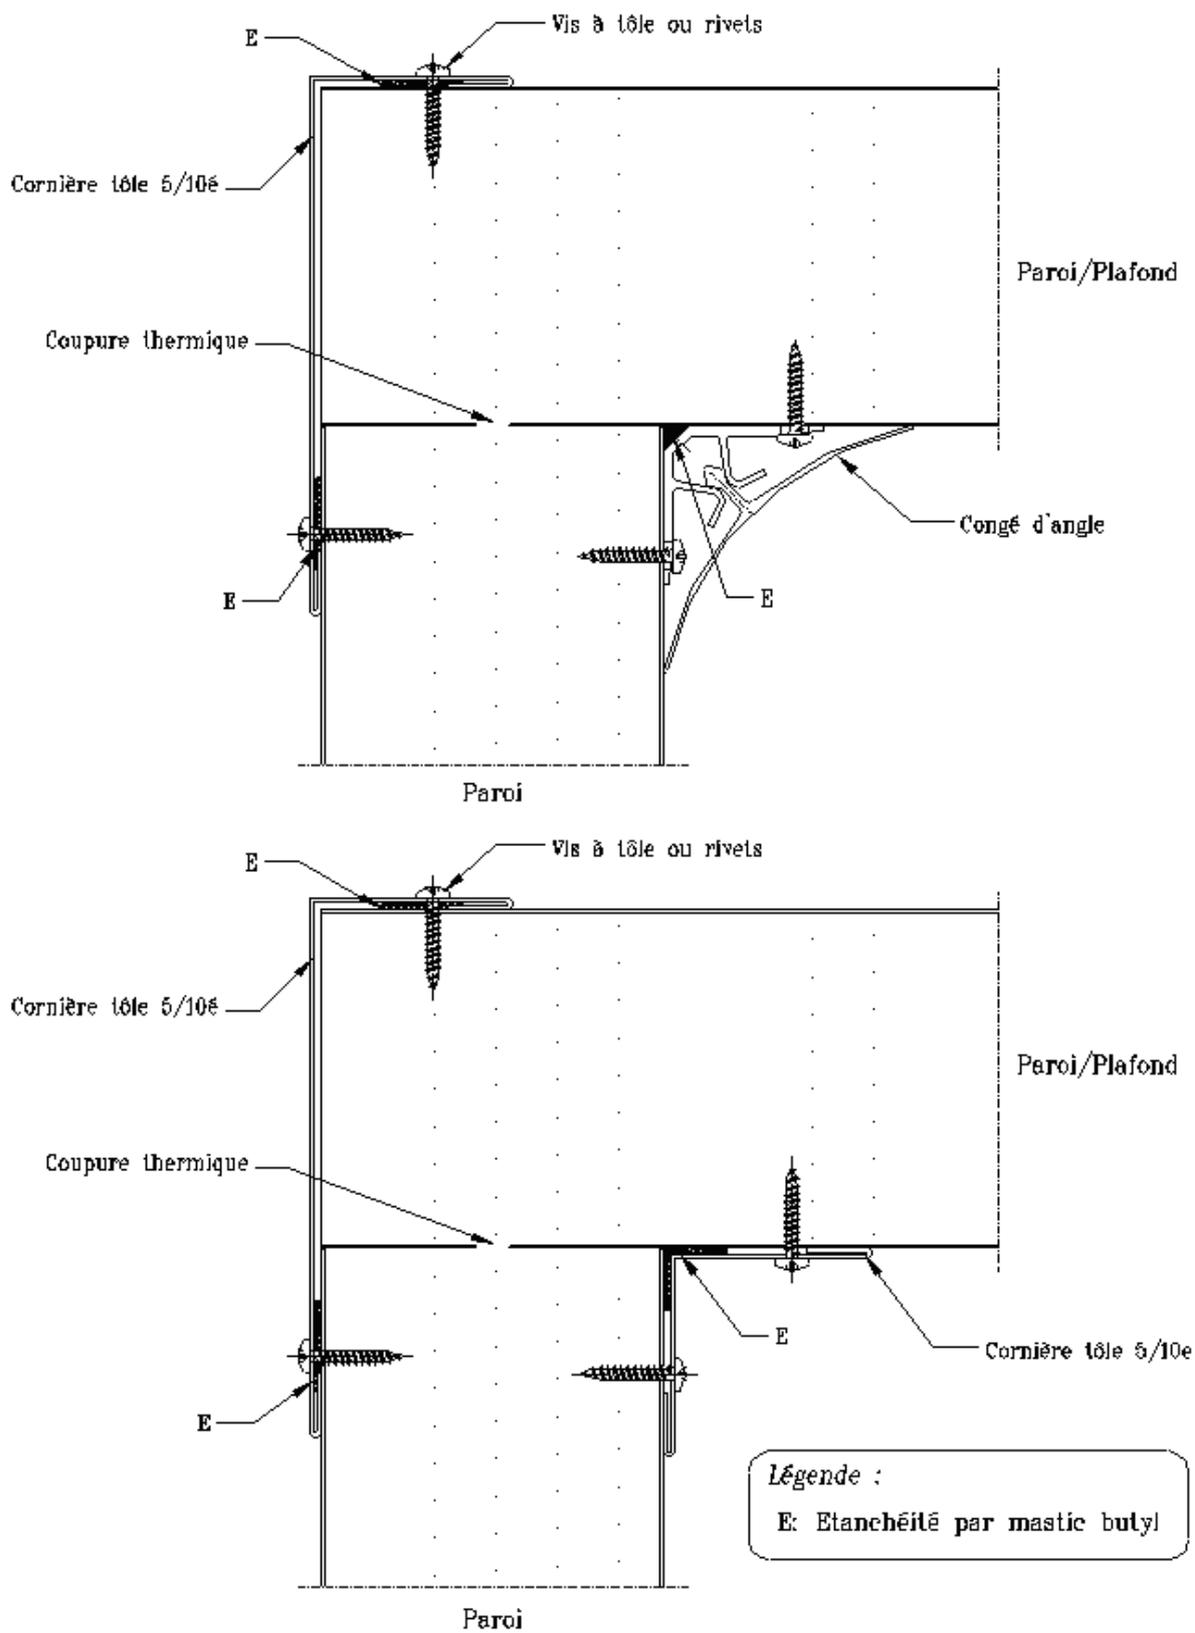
Jonction paroi – paroi en angle ou paroi – plafond
